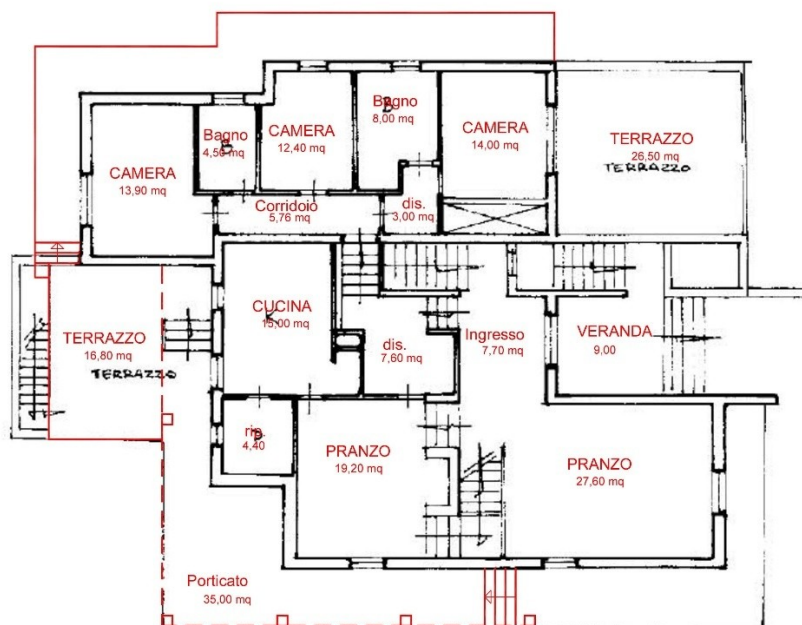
Planimetria stato di fatto piano terra con superfici
